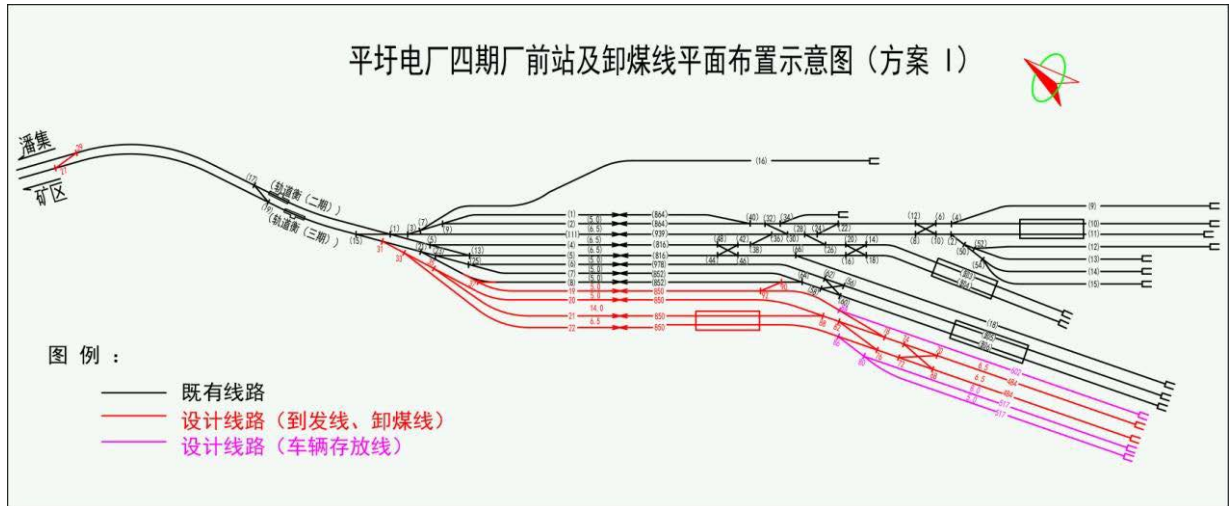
平圩电厂四期工程厂前站及卸煤线平面布置示意图
